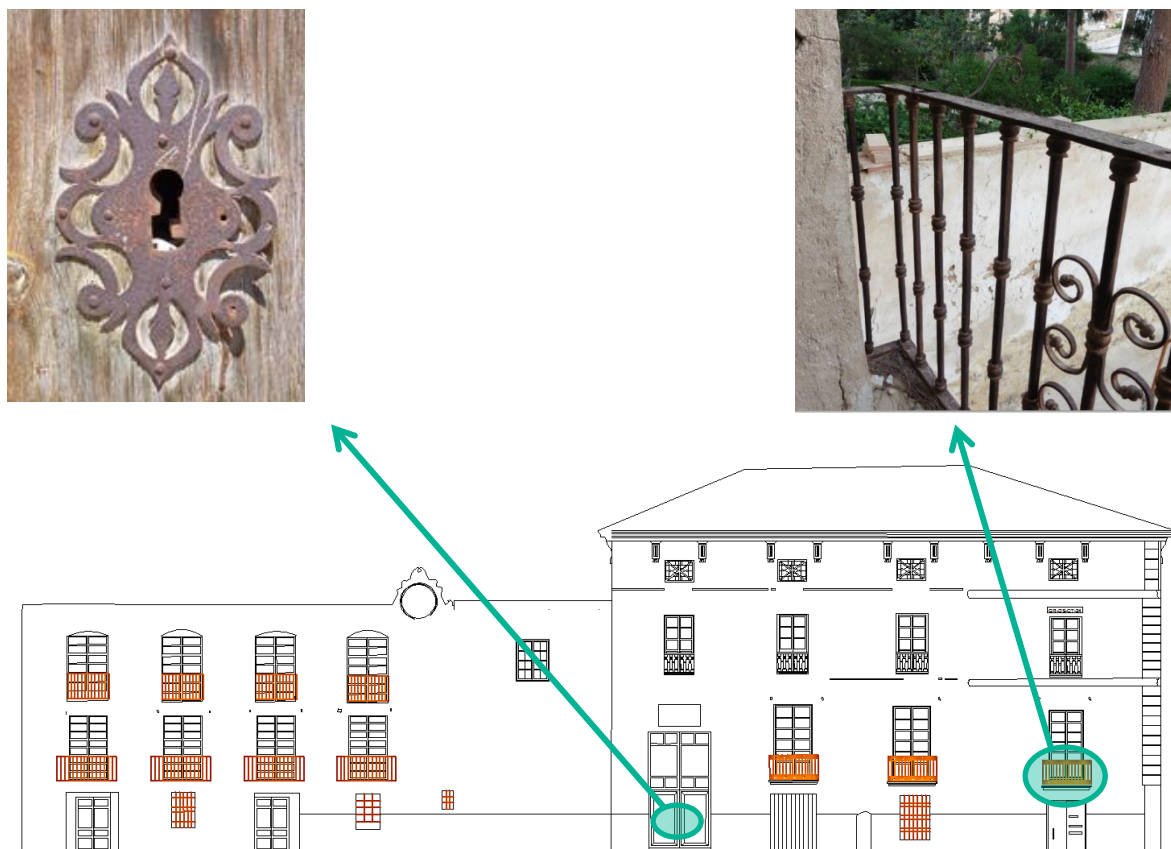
Alzado plaza. Oxidación. Fuente: Elaboración propia
